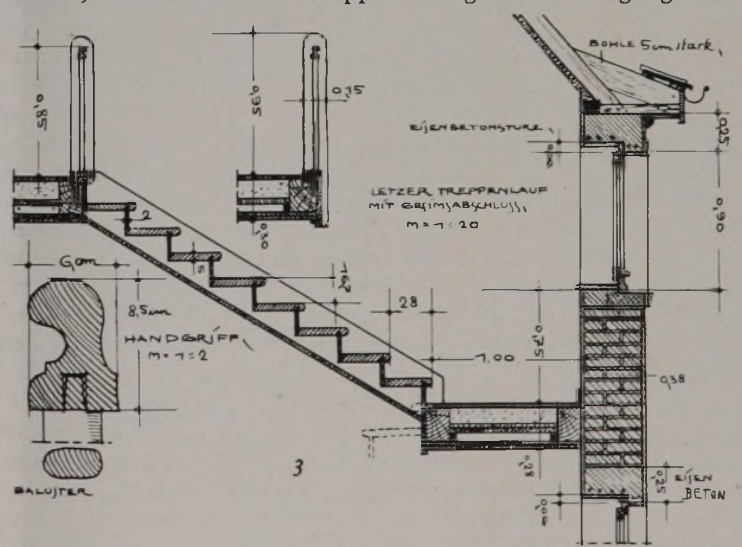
Oberer Treppenlauf mit Dachanschnitt für ein Siedlerhaus. Einfachste Ausführung und Profilierung, jedoch unrichtige Verbindungen. Das untere Einfalzen und obere Einmuten in die Trittstufen ist eine falsche Konstruktion; die Treppe knarrt schon nach kurzer Zeit. Der Stufenvorsprung ist mit 6 cm zu groß, das halbrunde Stufenprofil unpraktisch. Der Aufschiebling über der Traufe ist für Ziegeldeckung zu flach und führt zur Undichtigkeit.
